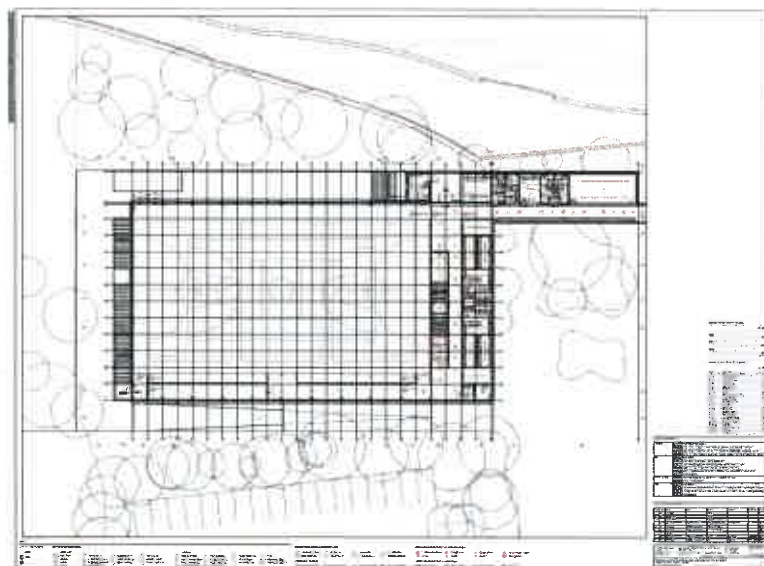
Primeira versão da planta do piso -1 com a ligação do novo edifício ao edifício principal
